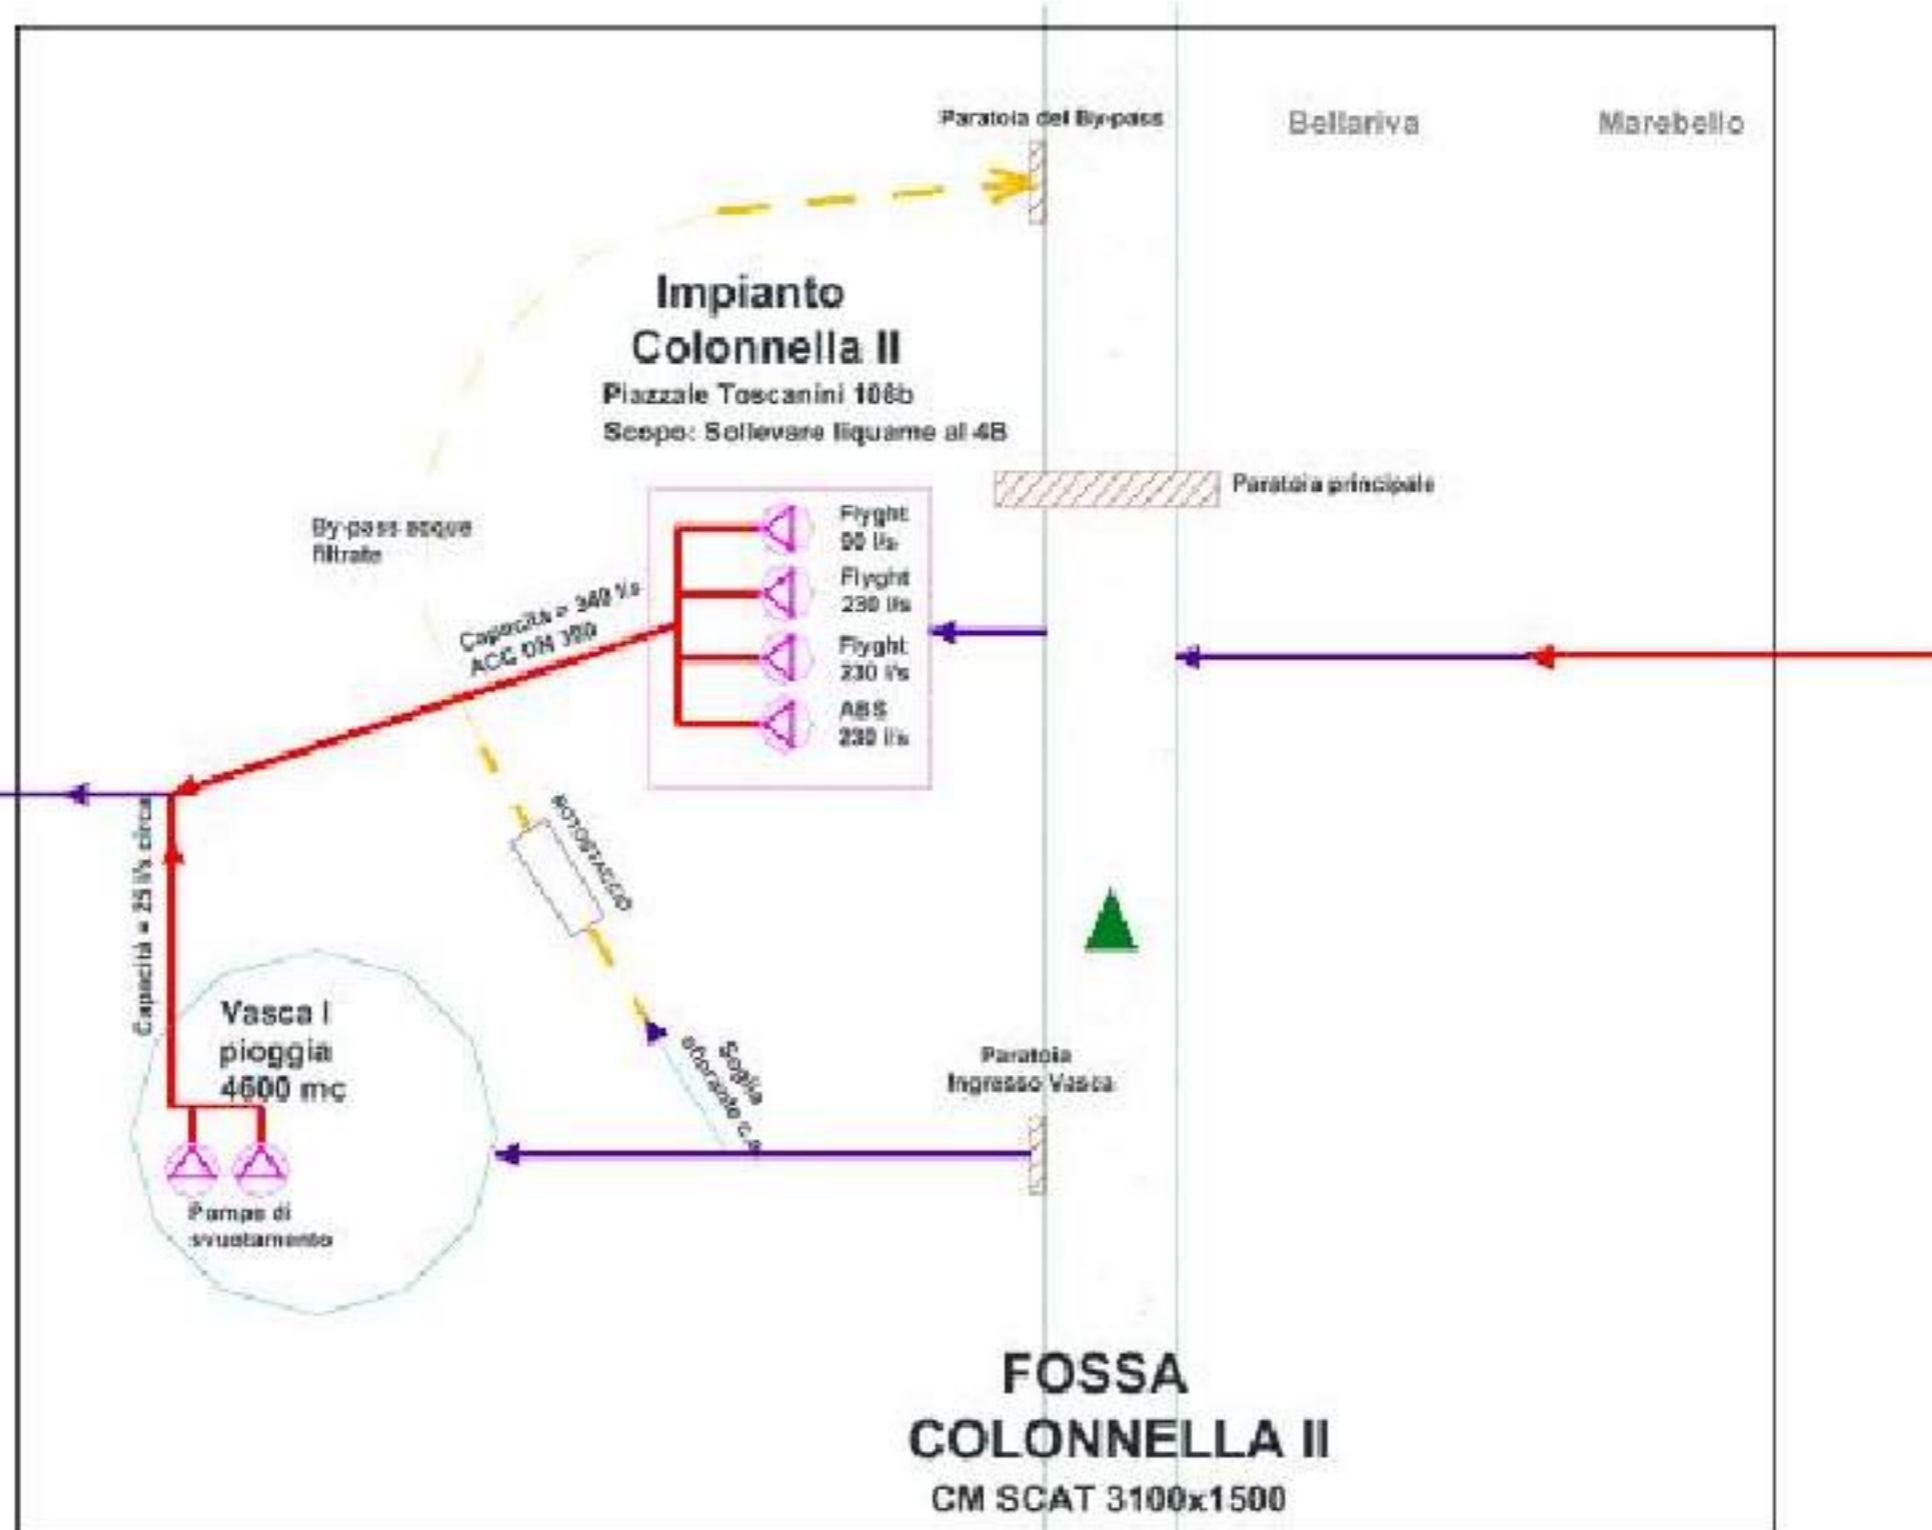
Schema planimetrico del tratto terminale della fossa Colonnella II
